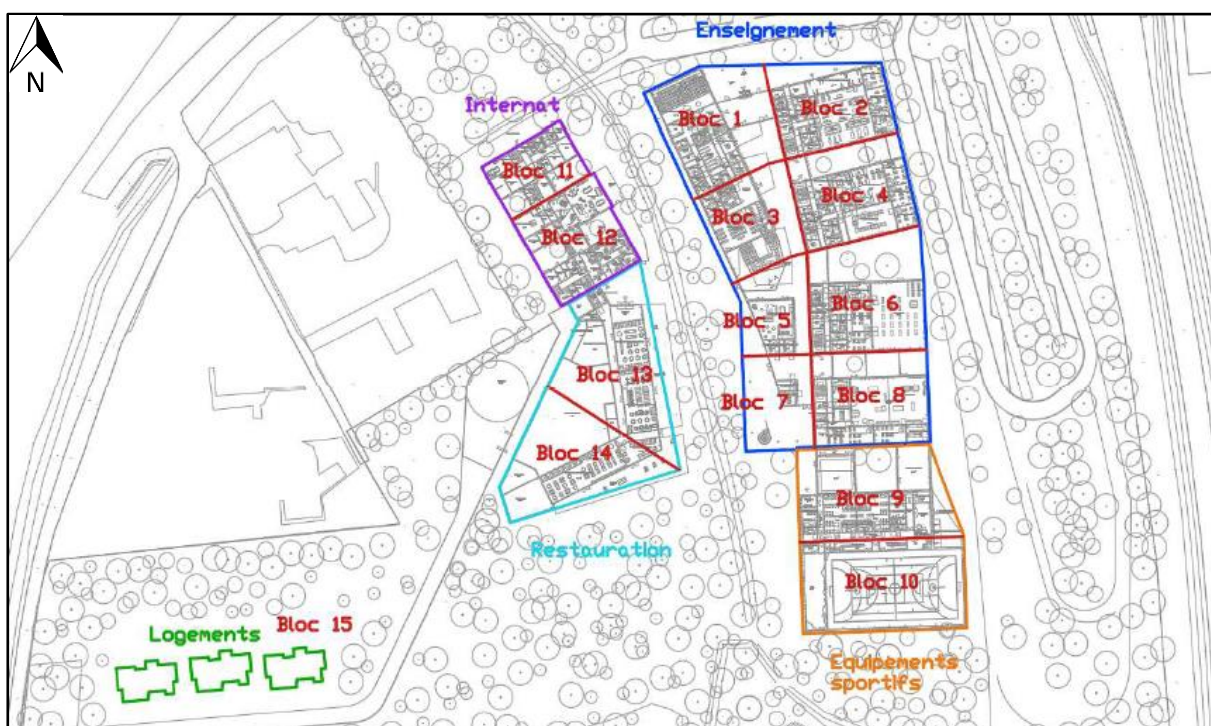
Plan de repérage des bâtiments et blocs projet (source : CCTP)
